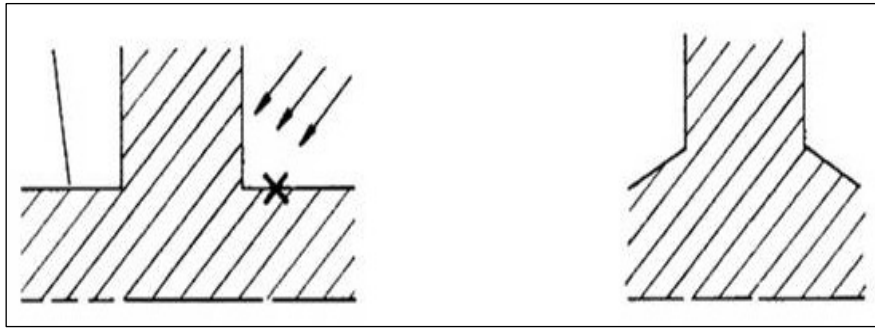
Influência de pormenores arquitectónicos no dimensionamento de estruturas (Coutinho, 1998).
